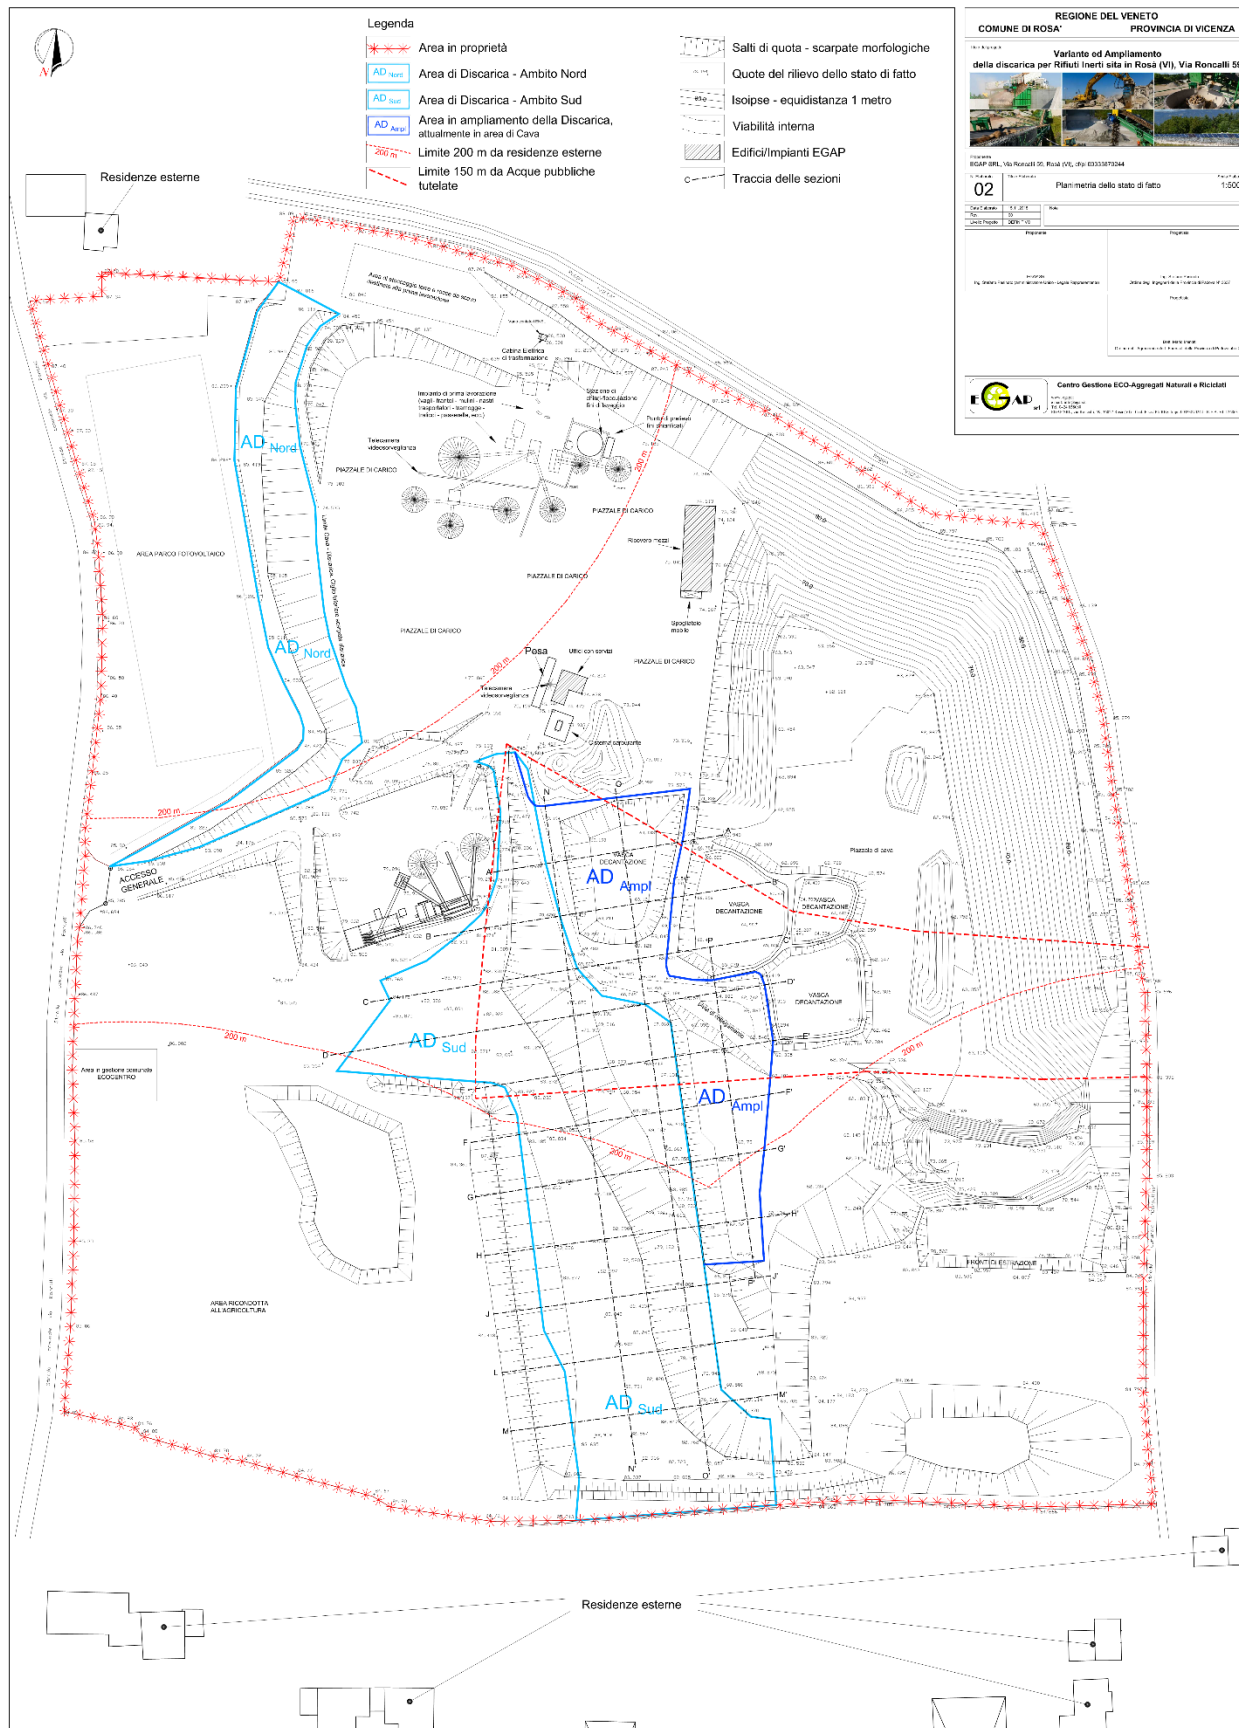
Elaborato n. 02 – PLANIMETRIA DELLO STATO DI FATTO. Area di Discarica AD con evidenza degli ambiti ADSud, ADNord e della porzione in ampliamento ADAmp.
